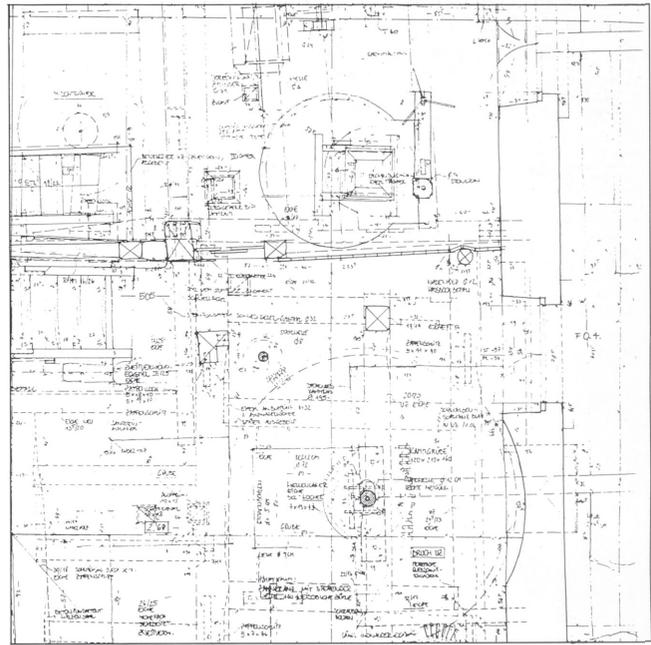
Verformungsgetreues Handaufmaß, gezeichnet im M 1:25. Strözbacher Doppelmühle, Landkreis Aschaffenburg, 1985. Ausschnitt Erdgeschoßgrundriß: Komplexes Ineinanderzeichnen von übereinanderliegenden Konstruktionselementen und maschinenmechanischen Details der Mühlenmechanik (Archiv Bingenheimer/Hädler).
